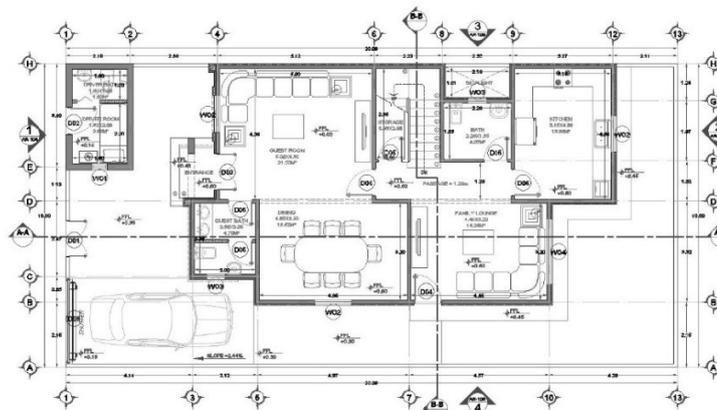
Planta baja arquitectónica. Proyecto Al Olaya.
